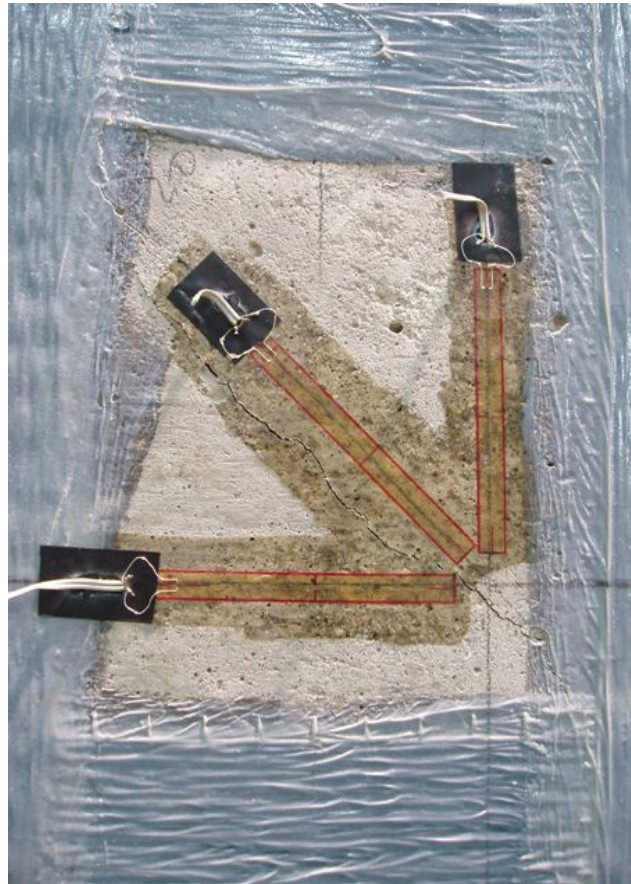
Detalhe dos extensômetros colados no concreto da viga VTL3.
